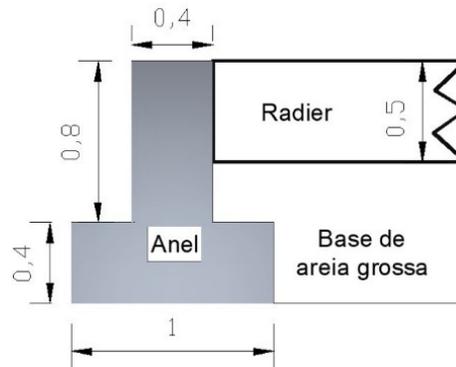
Seção do anel de concreto (medidas em metros)
